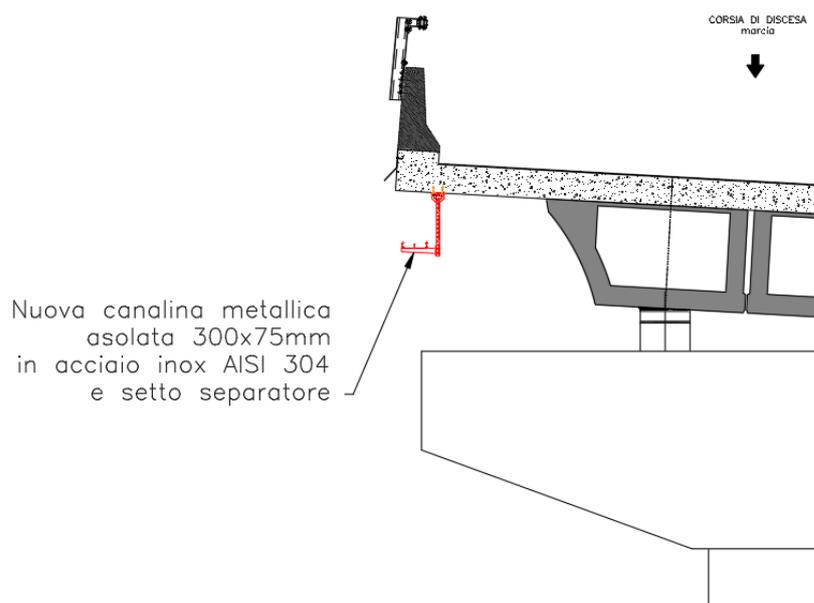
Sezione viad. Perilleux impalcato di discesa con posizionamento nuova canalina impianti tecnologici
